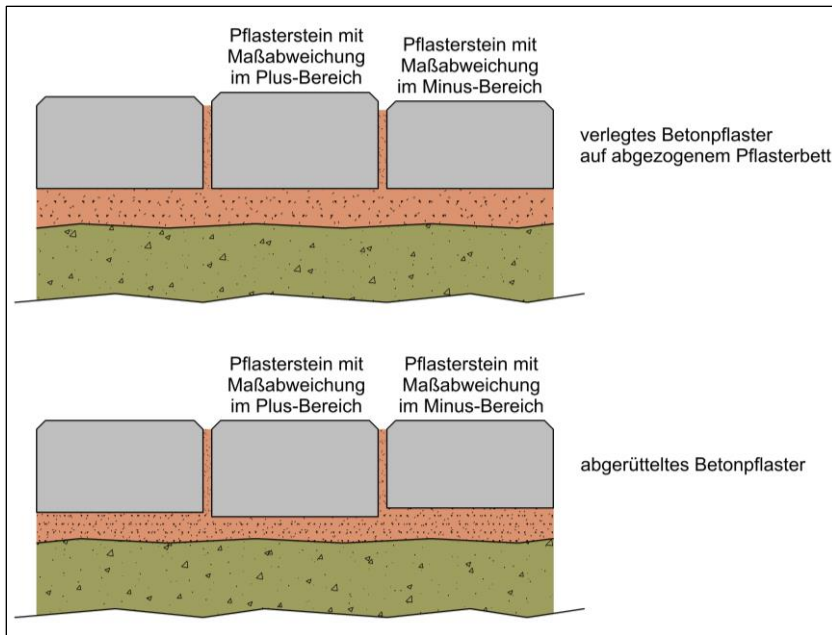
Ausgleich zulässiger Dickentoleranzen der Betonpflastersteine innerhalb der Bettung (Zeichnung: SLG)
